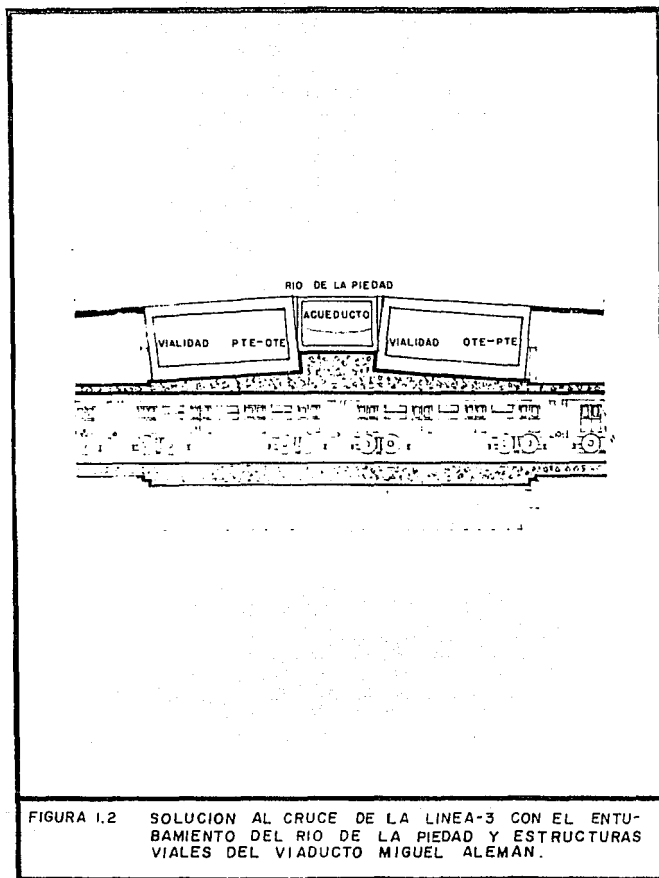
SOLUCION AL CRUCE DE LA LINEA-3 CON EL ENTUBAMIENTO DEL RIO DE LA PIEDAD Y ESTRUCTURAS VIALES DEL VIADUCTO MIGUEL ALEMAN.
